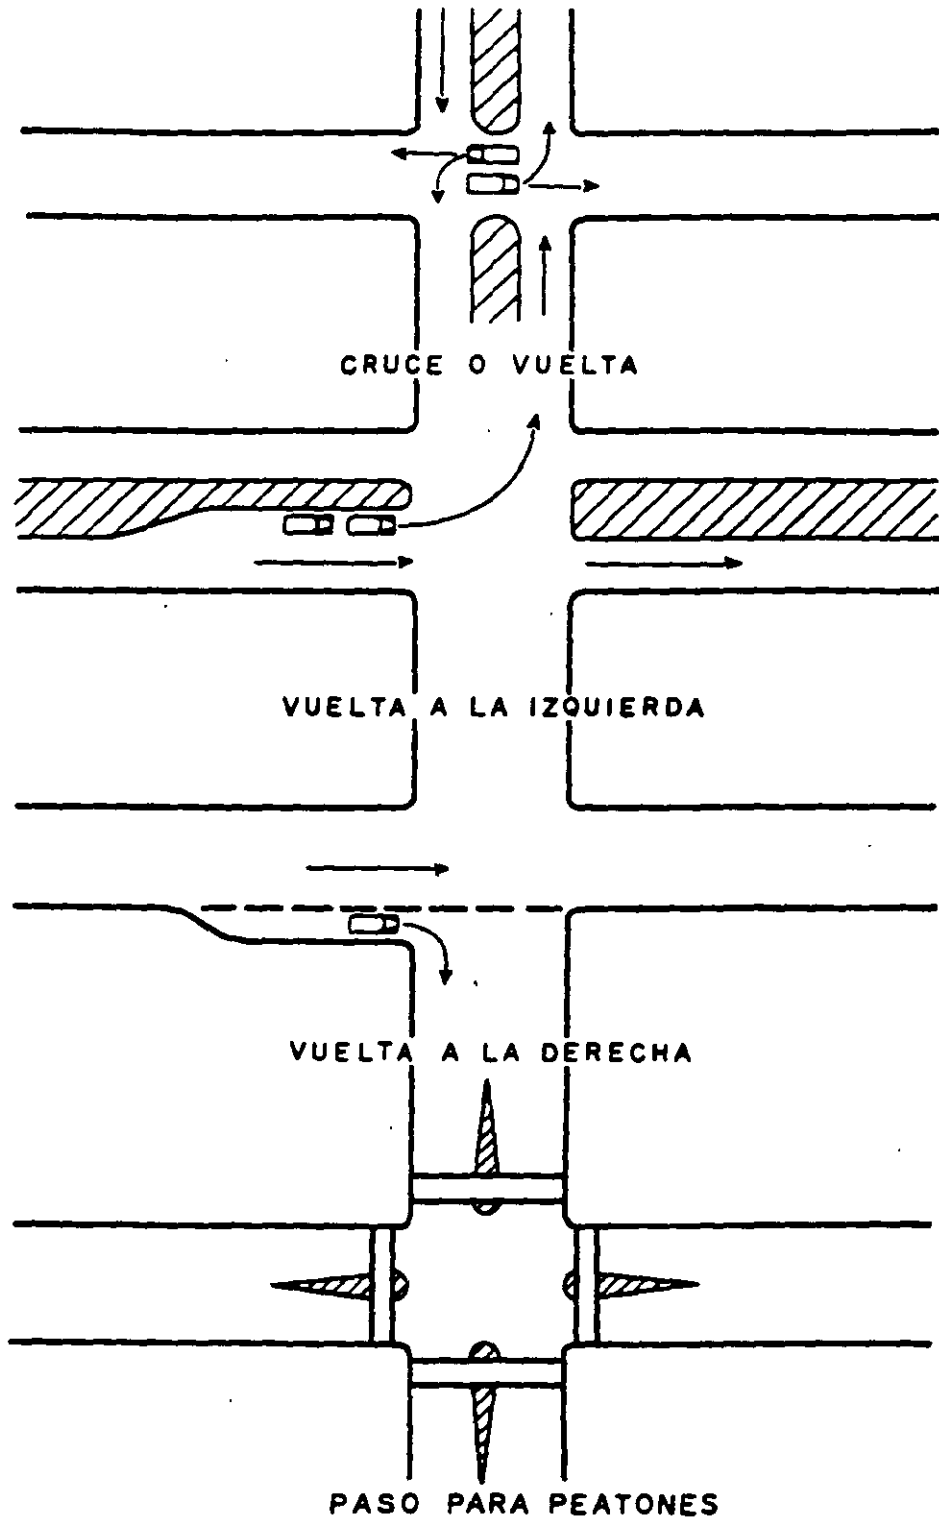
EJEMPLOS DE ZONAS DE PROTECCION
